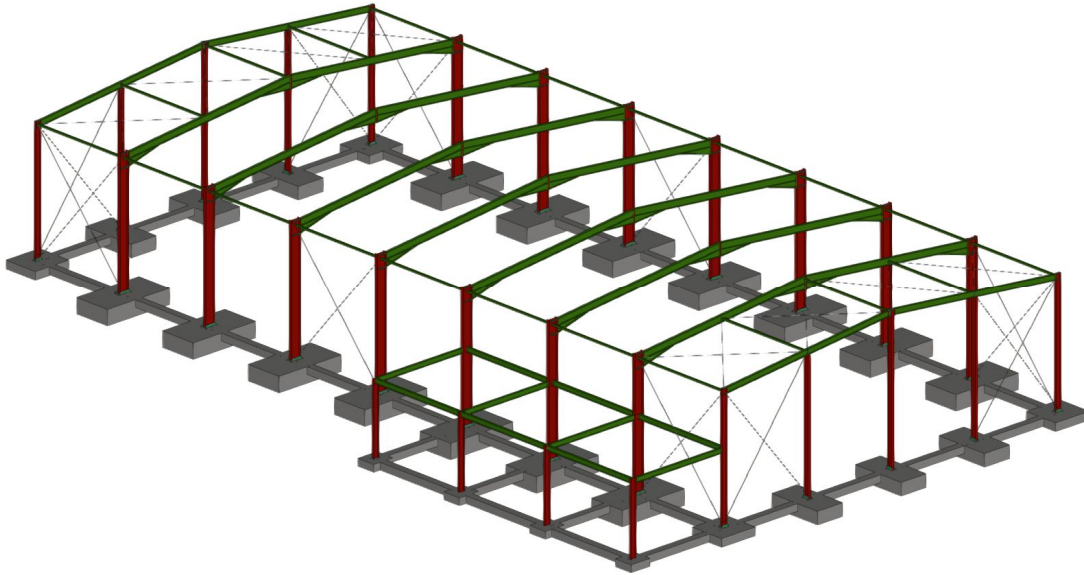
Estructura metálica y cimentaciones de la obra civil completa
